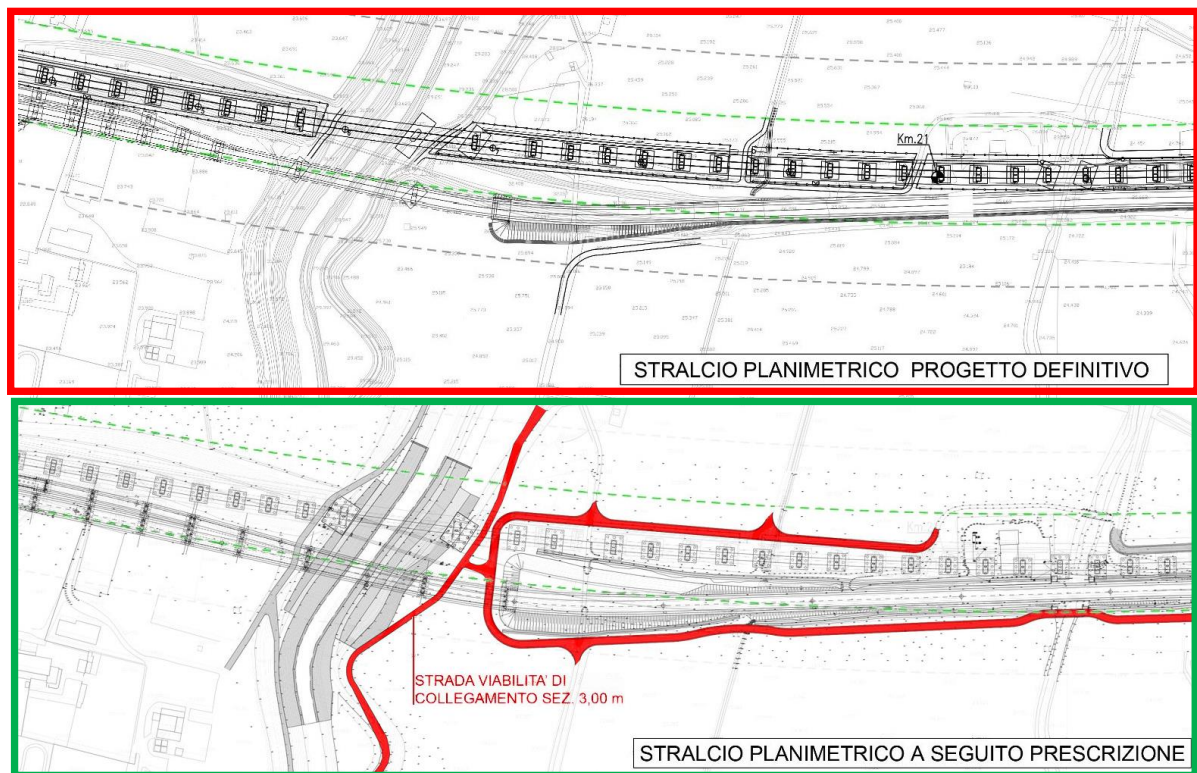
Confronto planimetria PD (rosso) e PE (verde)
